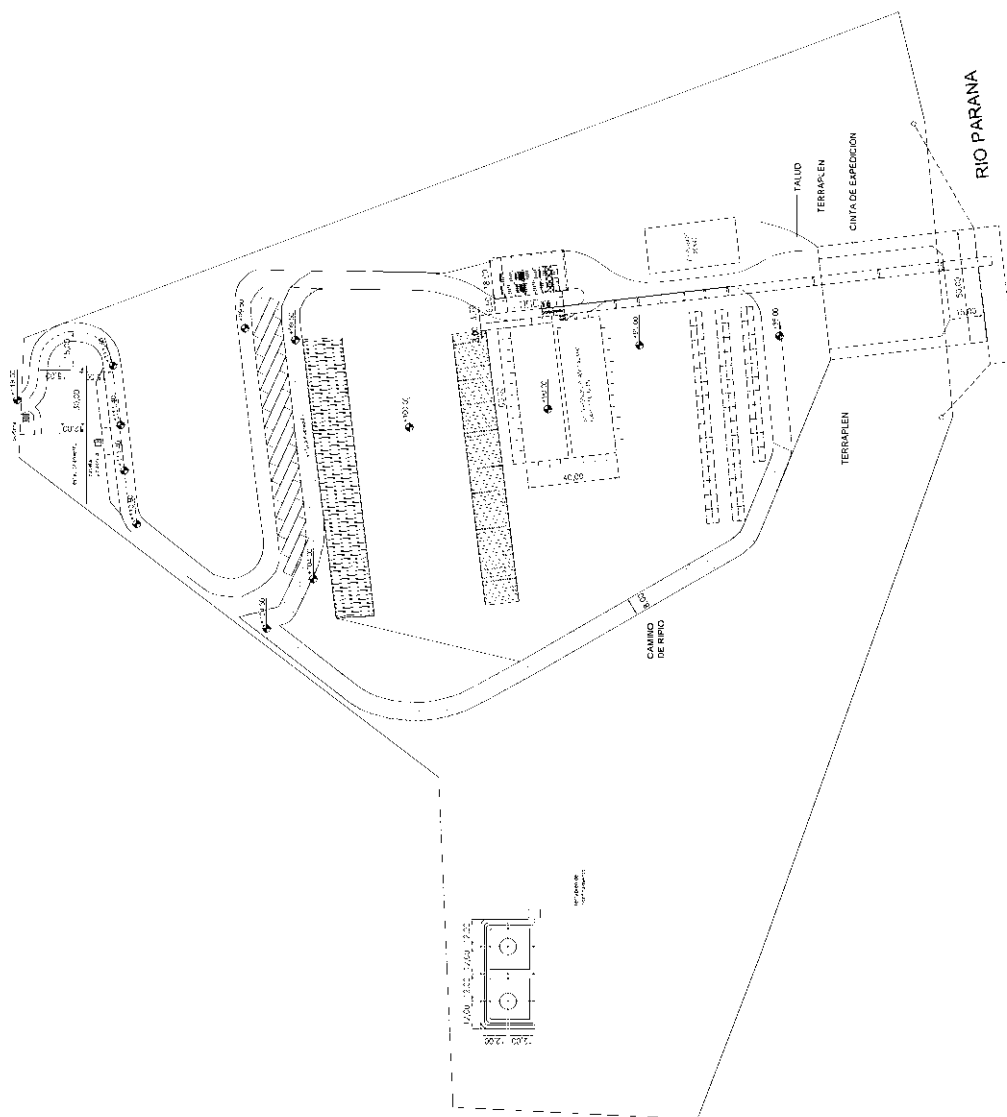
Plano Esquemático de la Disposición de las Instalaciones
